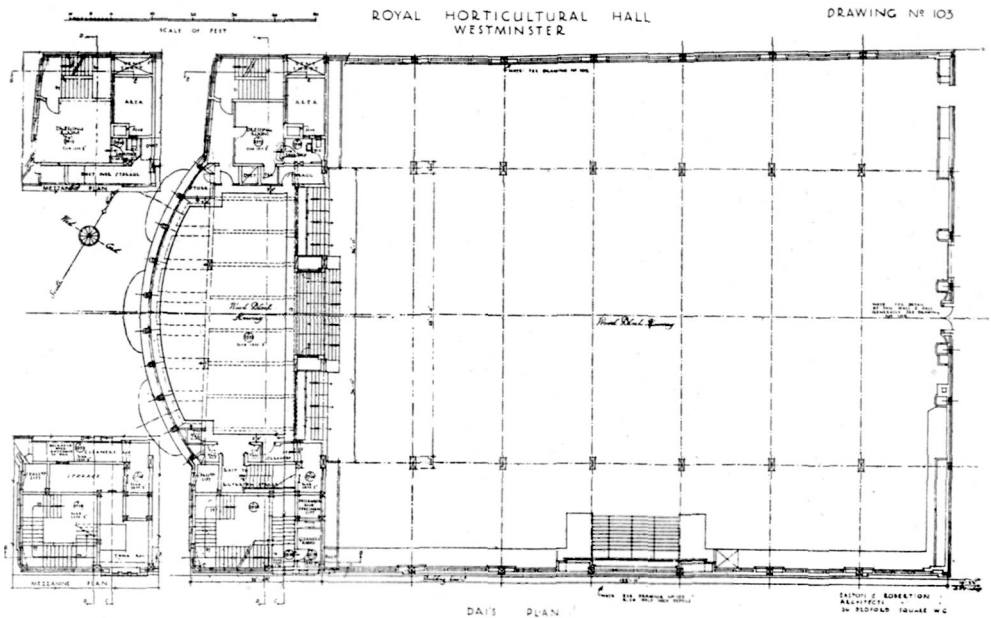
Royal Horticultural Hall zu London. Obergeschoß-Grundriß
